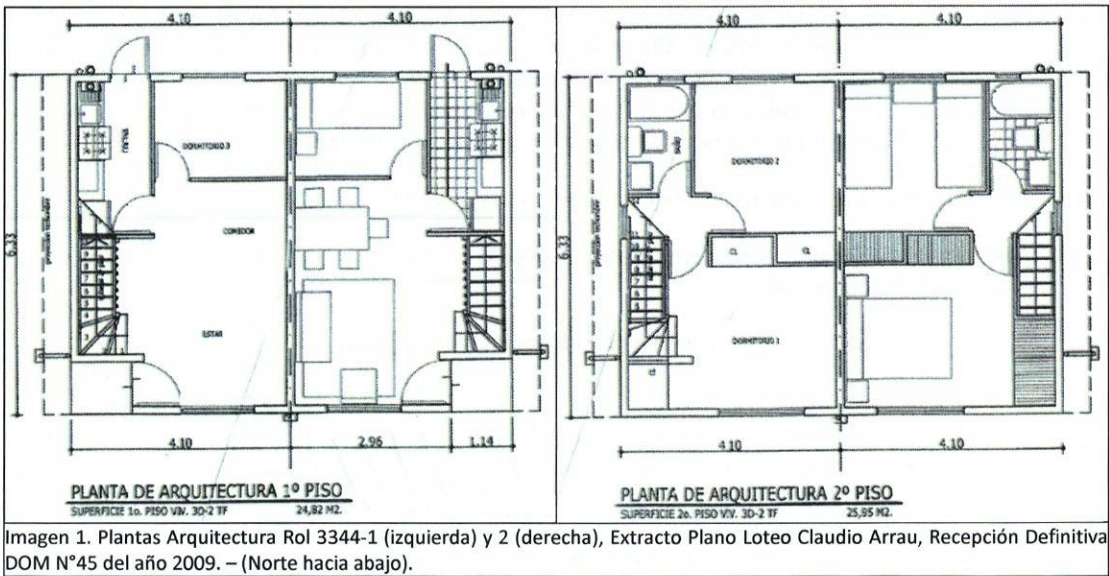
Plantas Arquitectura Rol 3344-1 (izquierda) y 2 (derecha), Extracto Plano Loteo Claudio Arrau, Recepción Definitiva DOM N°45 del año 2009. – (Norte hacia abajo).
